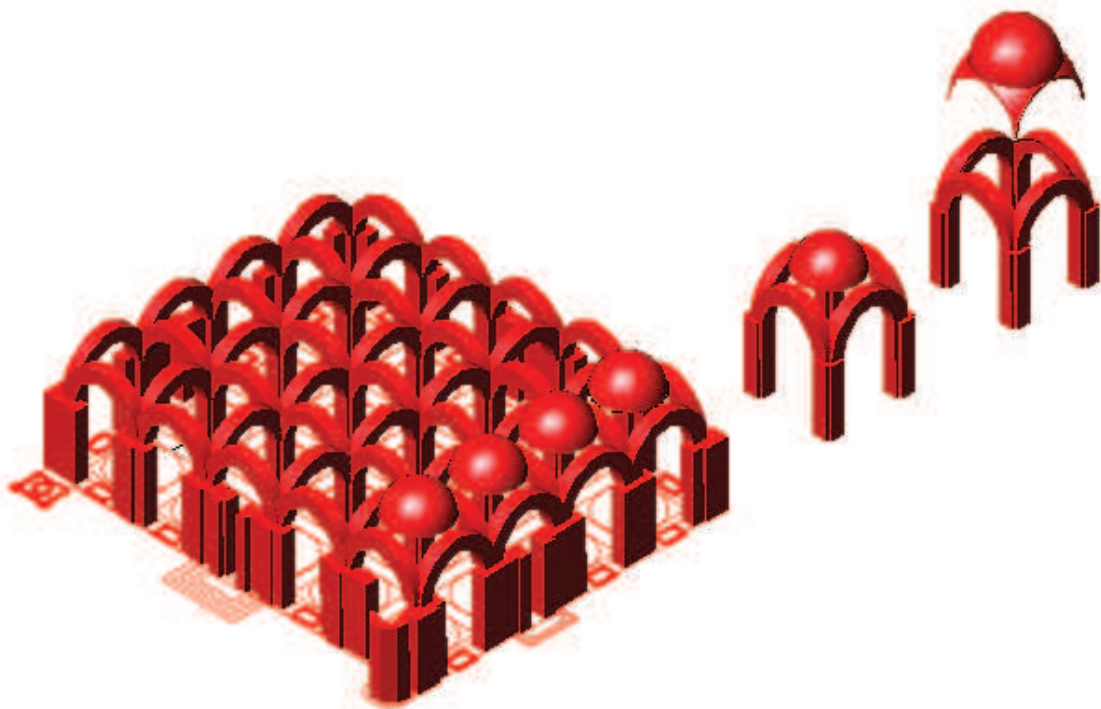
Ulu Camii, Esquema estructural. (Construcción 3D del autor)
